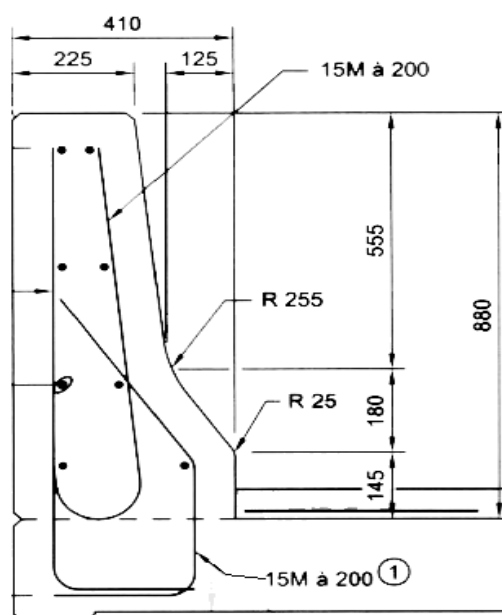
Design standard de parapet PL2/TL4 (MTQ, 2010)
